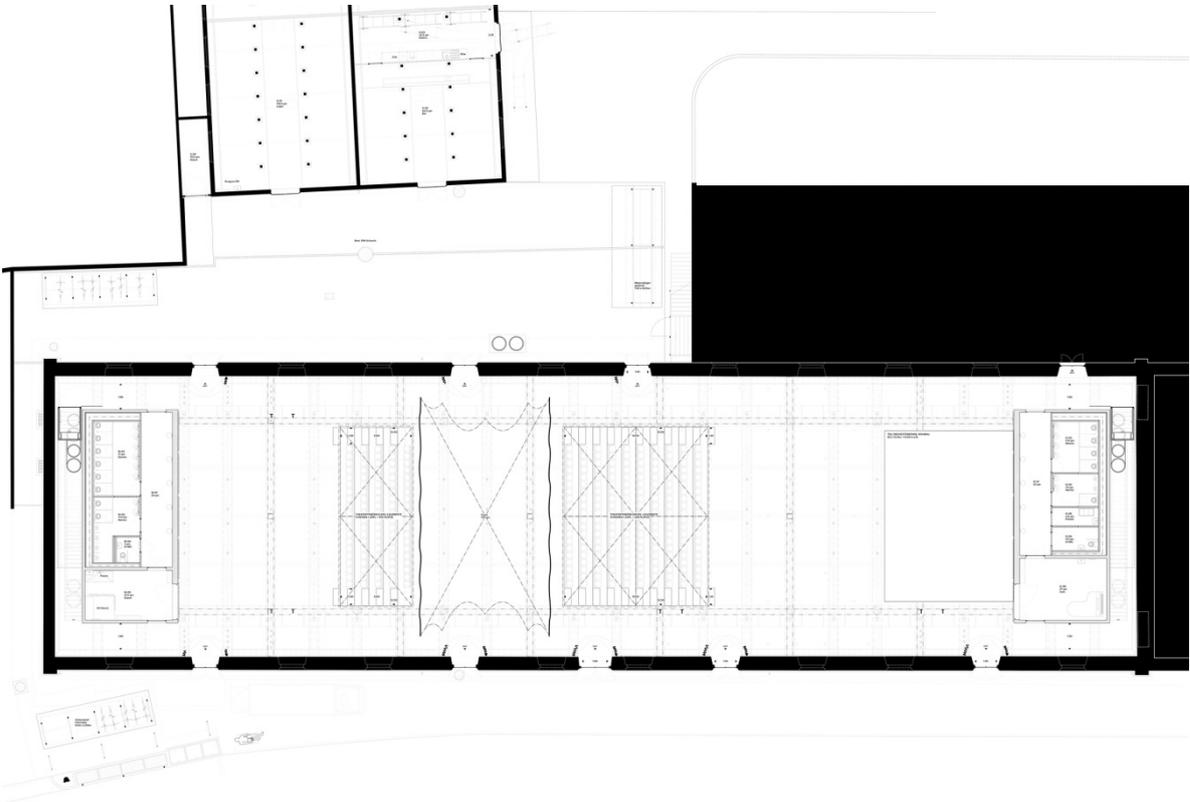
Grundriss Alte Reithalle mit Grunddisposition, ohne Massstab
